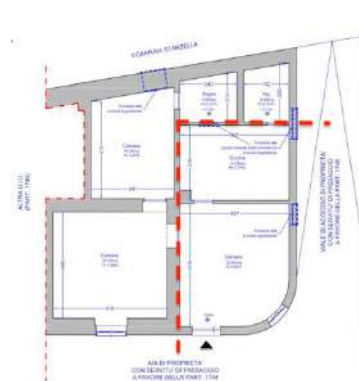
Planimetria dello Stato di fatto (cfr. All. 9b) dell'appartamento in II Carraia di Via Starzella
